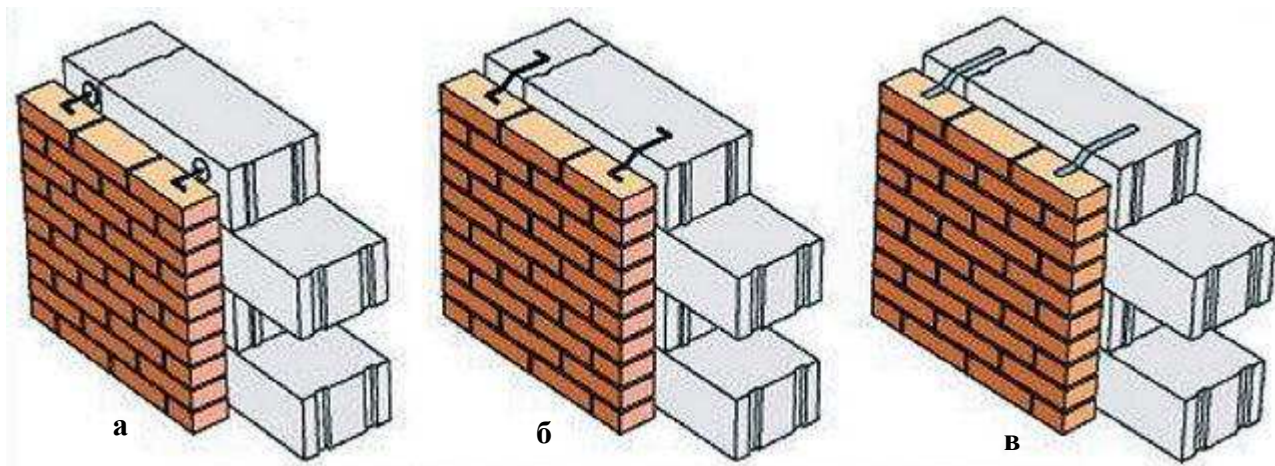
Способи кріплення облицювання до стіни з газобетонних блоків: а – простий анкер; б – Z-анкер; в – смуговий анкер
